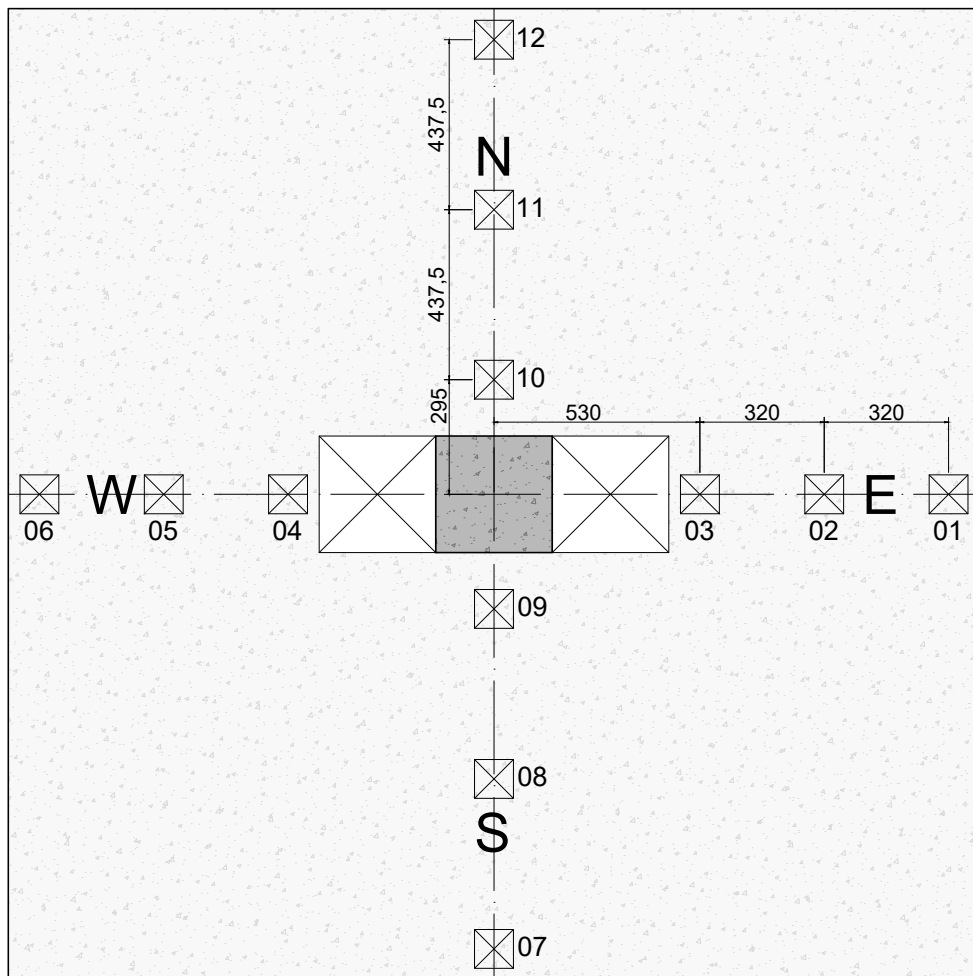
Posicionamento dos LVDTs nas lajes com aberturas [mm]
